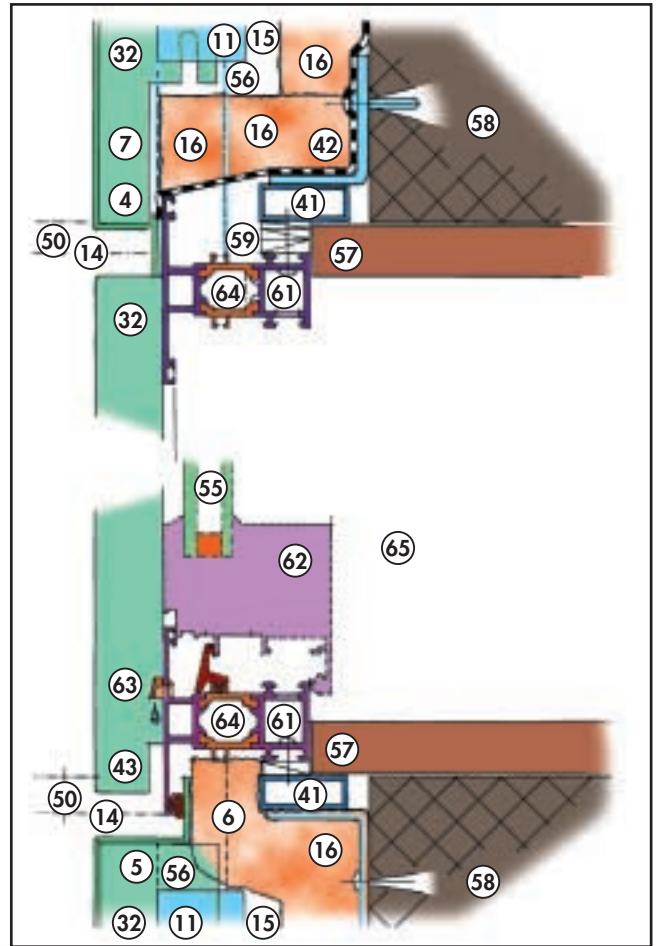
b) - Finestra complanare con il rivestimento - Sezione verticale
